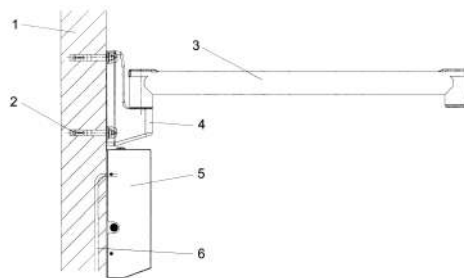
Bauteile Wandbefestigung mit Schwerlastanker oder Durchsteckanker
